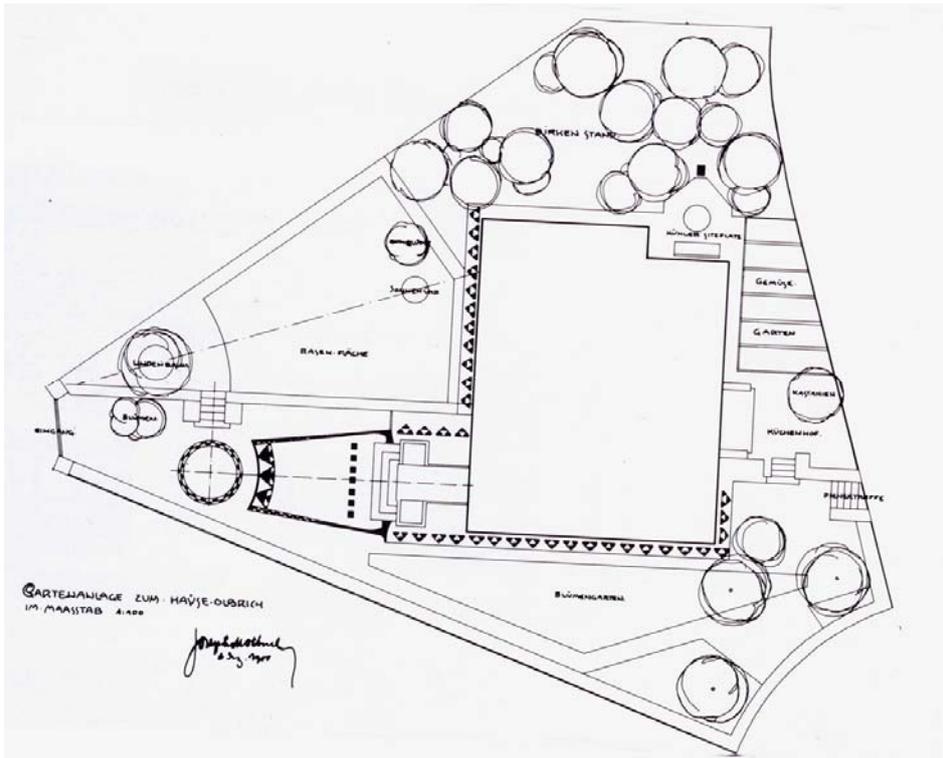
Haus Olbrich in Darmstadt. Situationsplan. 1900.
